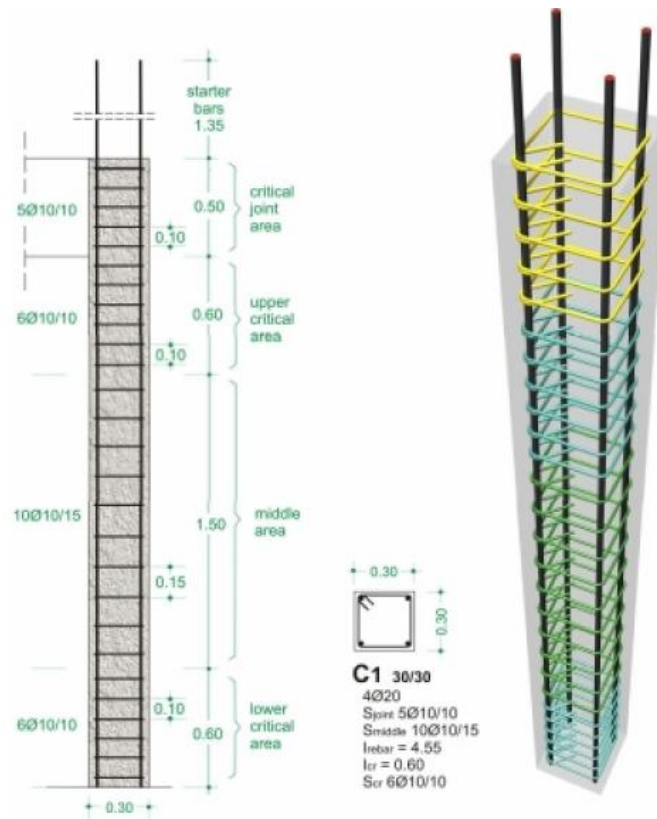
Répartition des aciers le long d'un poteau en béton armé.
